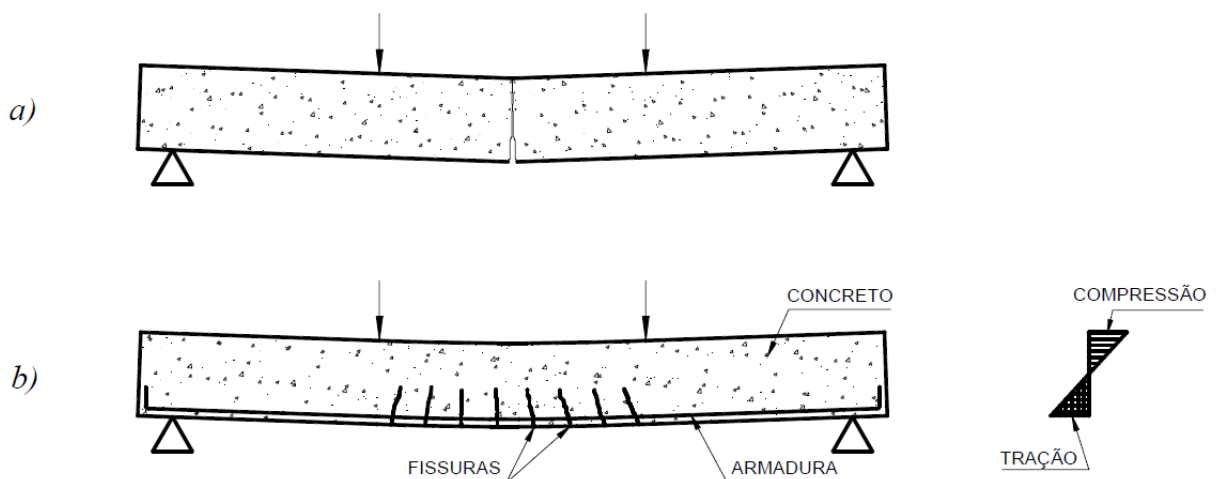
Viga de concreto simples (a) e viga de concreto armado (b)
